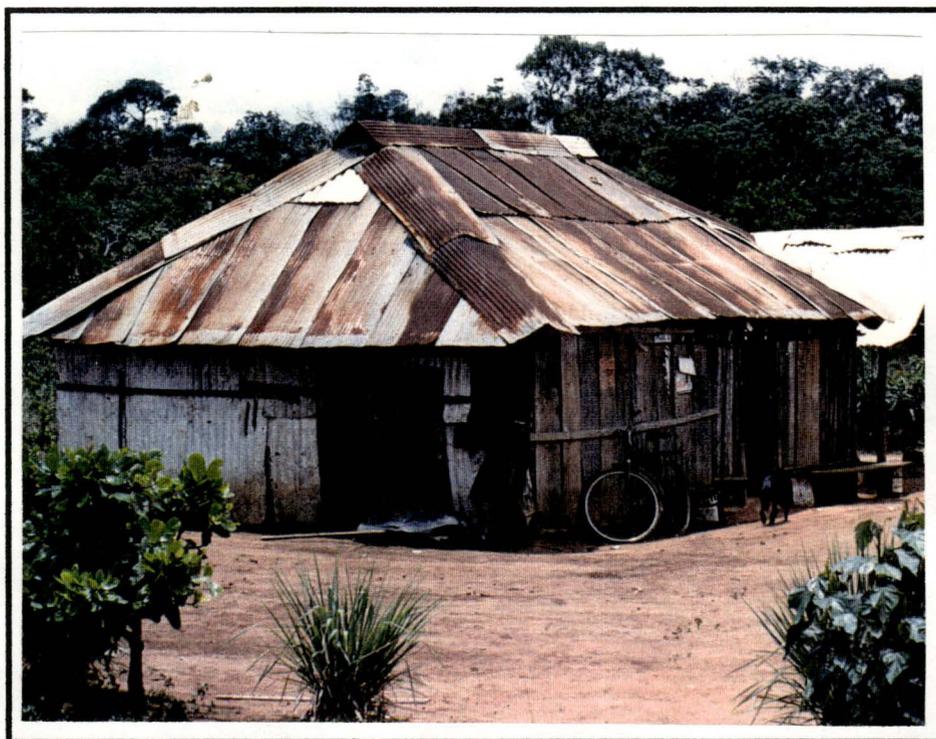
Habitação com utilização de madeira roliça e telha de zinco
